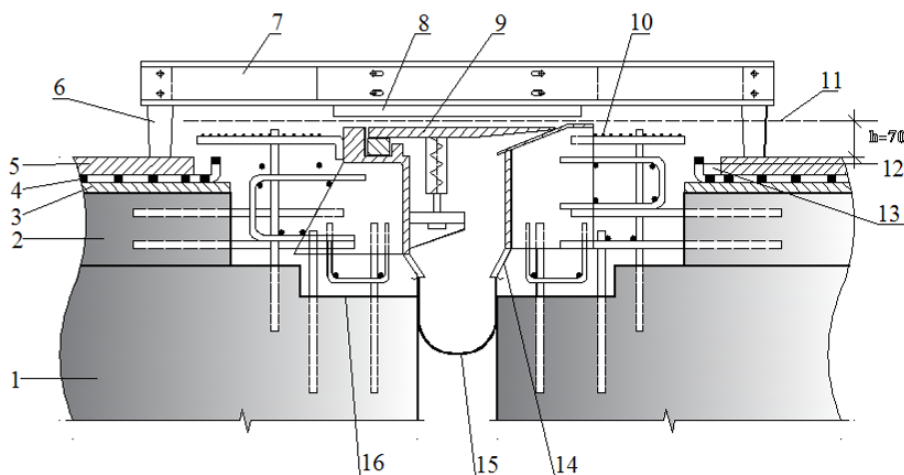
Схемы анкеровки некоторых конструкций деформационных швов в железобетонных пролётных строениях
